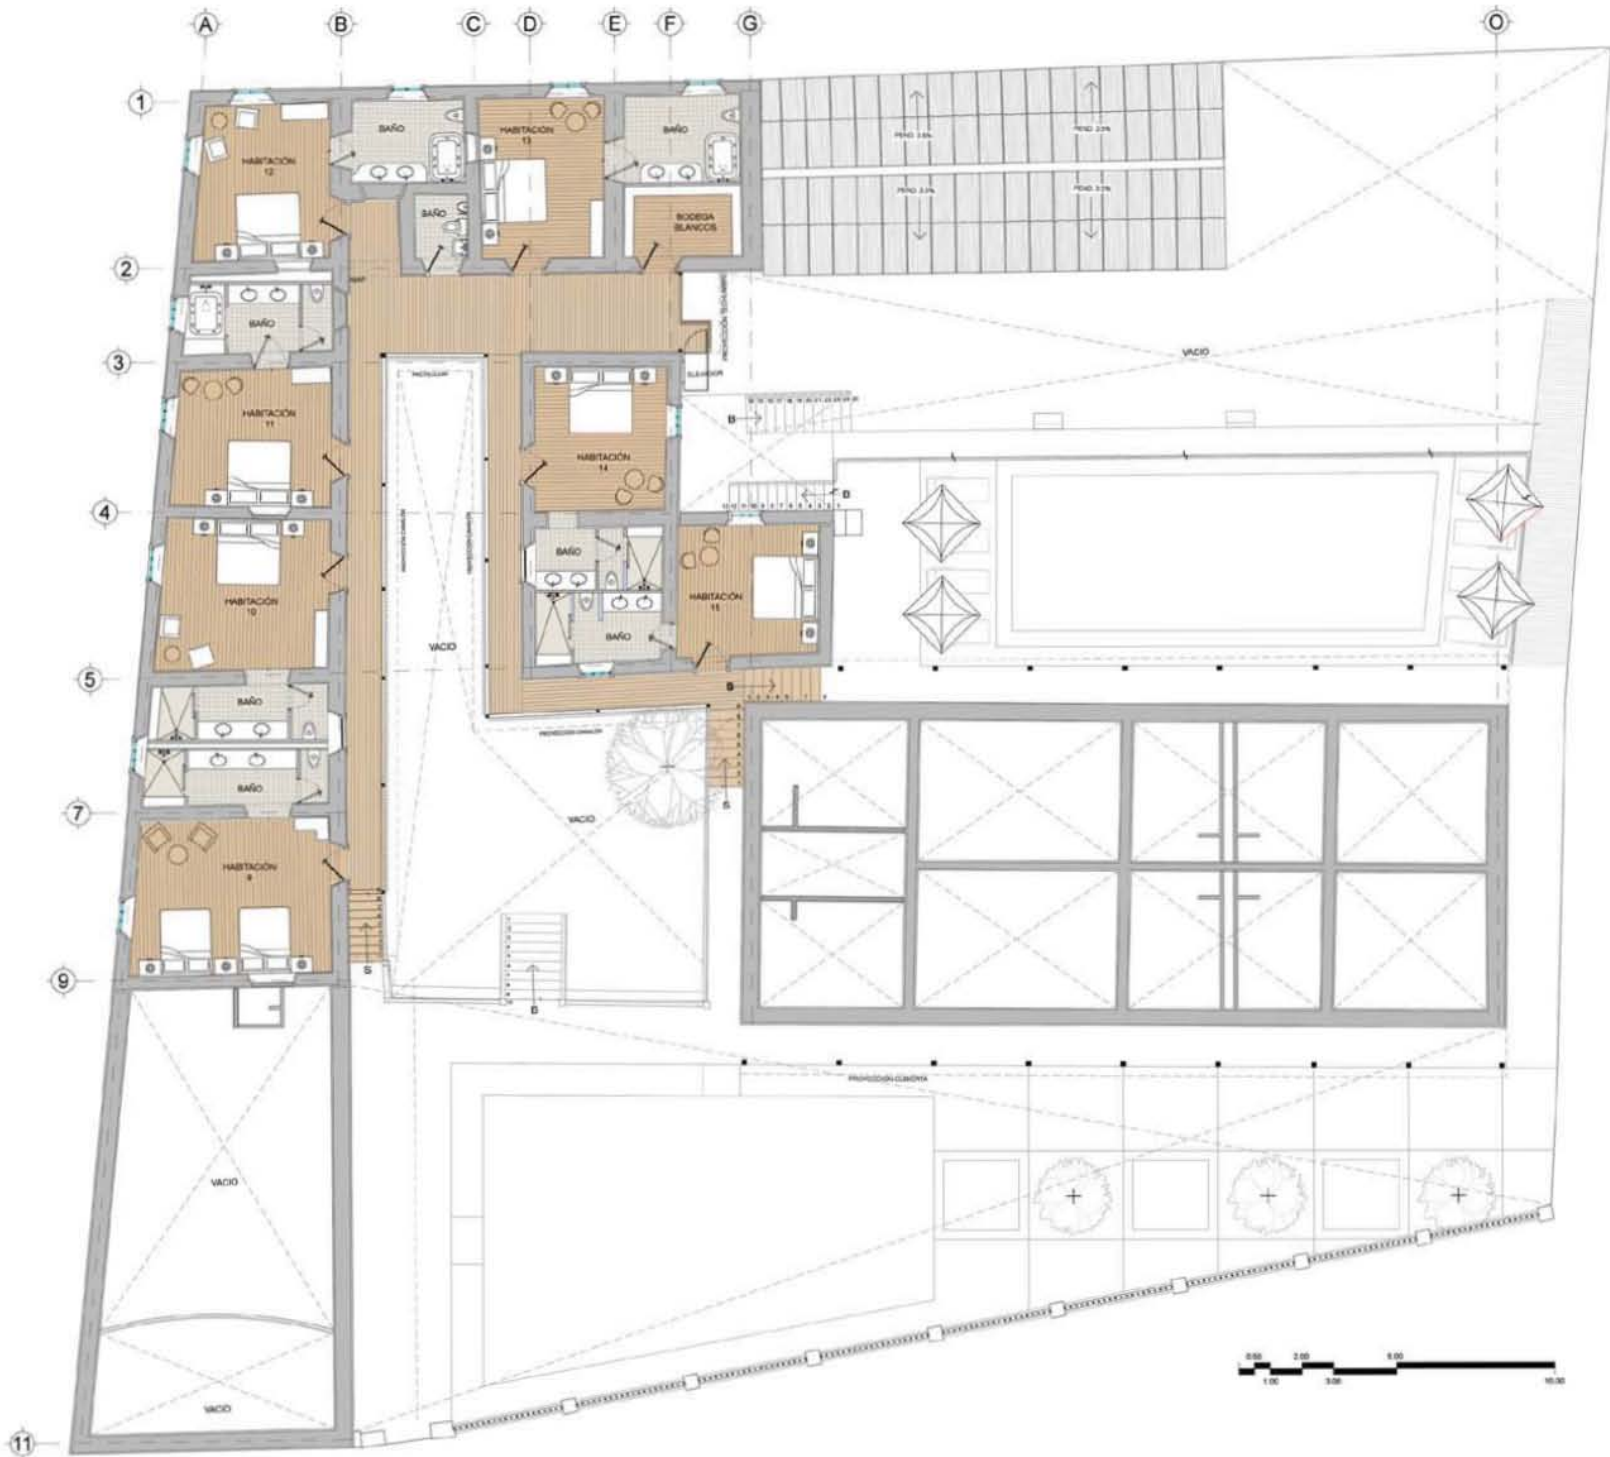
Planta alta del proyecto de adecuación del "Hotel del Jardín". Este nivel está destinado a habitaciones.
